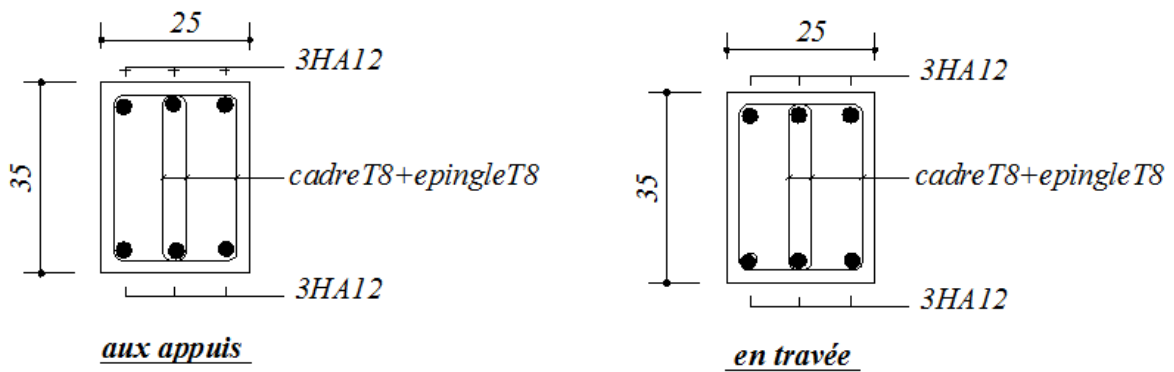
Le ferraillage de la poutre de chinage et Ferme
